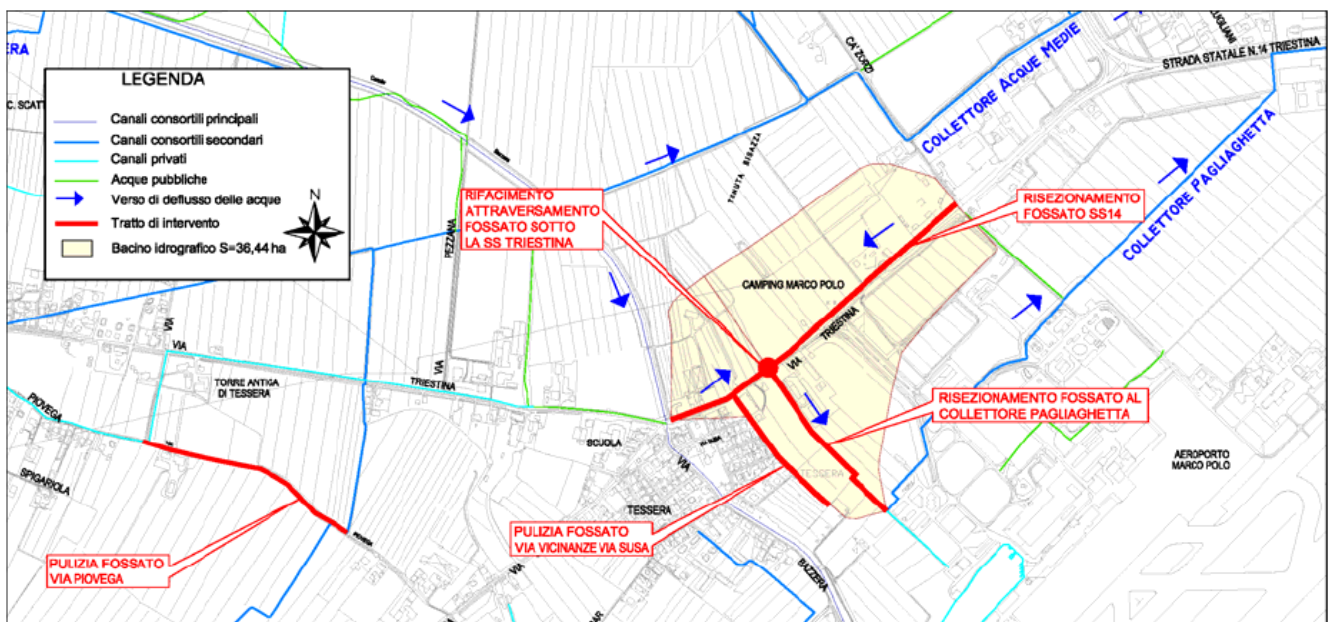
Interventi previsti per la risoluzione della criticità N.2 - planimetria (estratto dal Piano delle Acque del Comune di Venezia).
